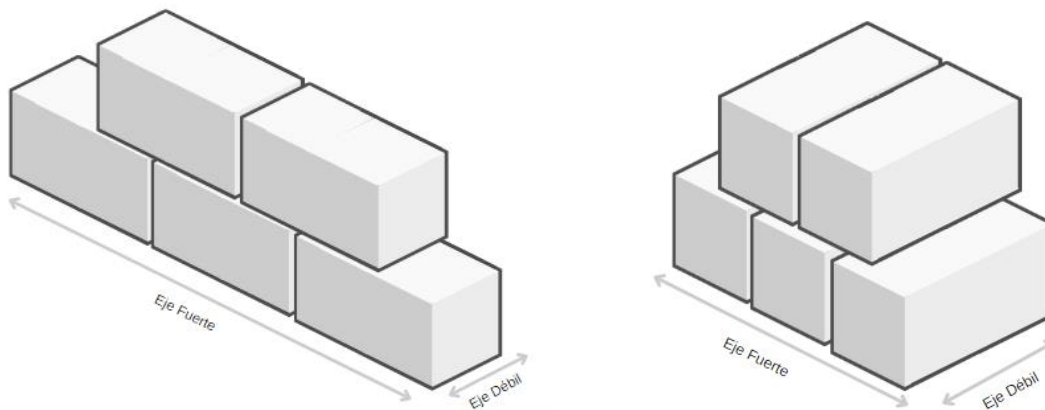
Elaboración propia. A la izquierda distribución de bloques de adobe en muros modernos. A la derecha distribución de bloques de adobe en muros antiguos.
